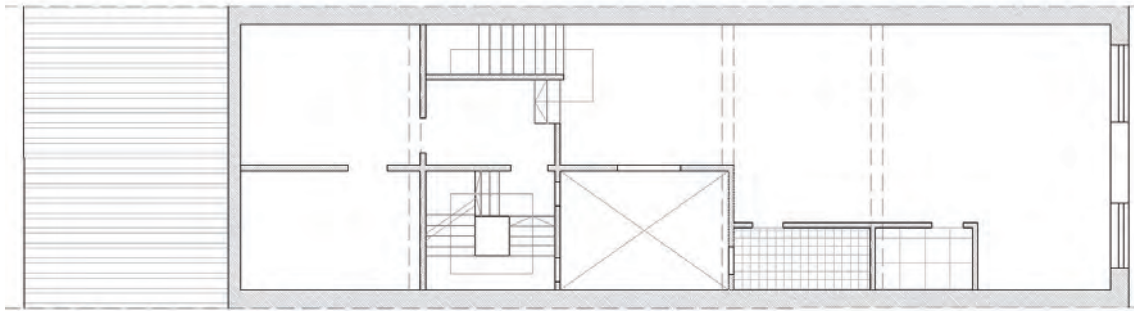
11. CUARTA PLANTA. PLANTA BAJOCUBIERTA
